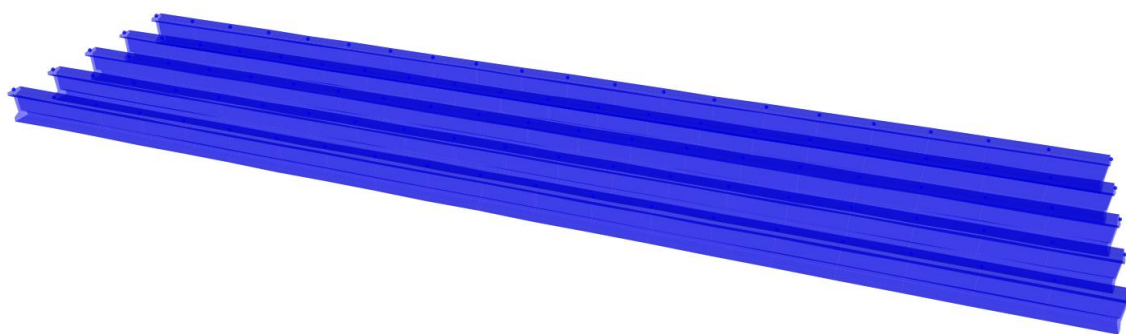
Vista extruida de las barras longitudinales con las secciones de viga asignadas
